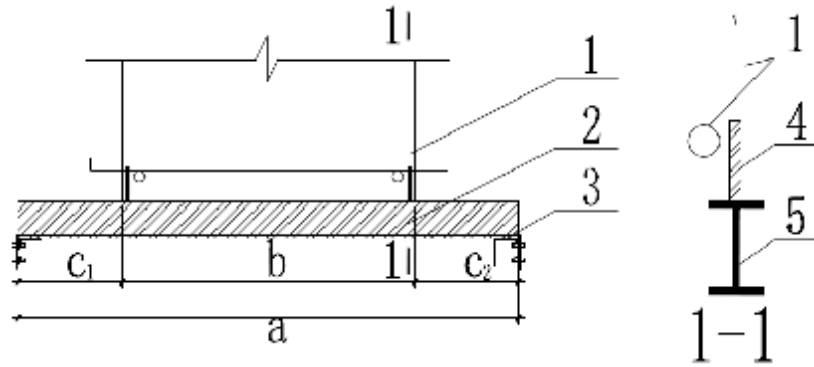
工字钢上焊定位点剖面示意图
